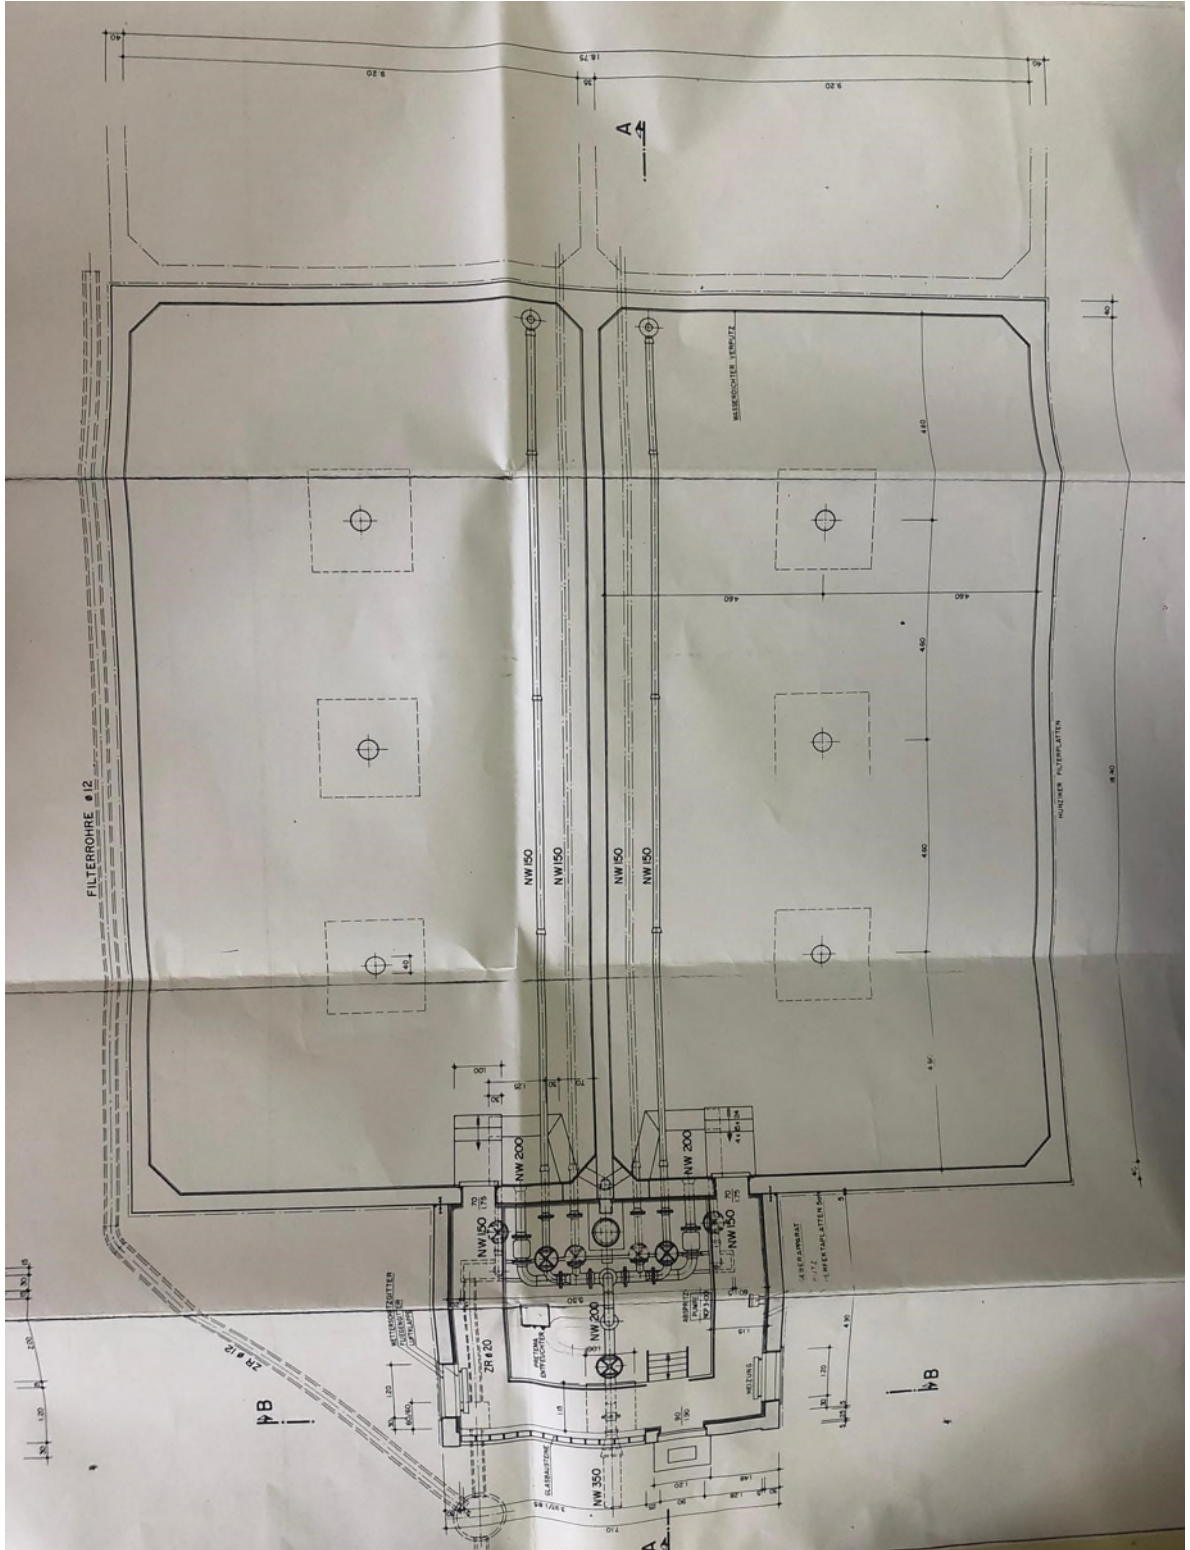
Grundriss Res. Rütene in Lupfig
